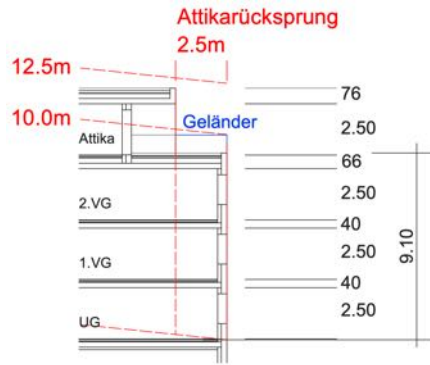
Herleitung der erforderlichen Fassadenhöhe.
